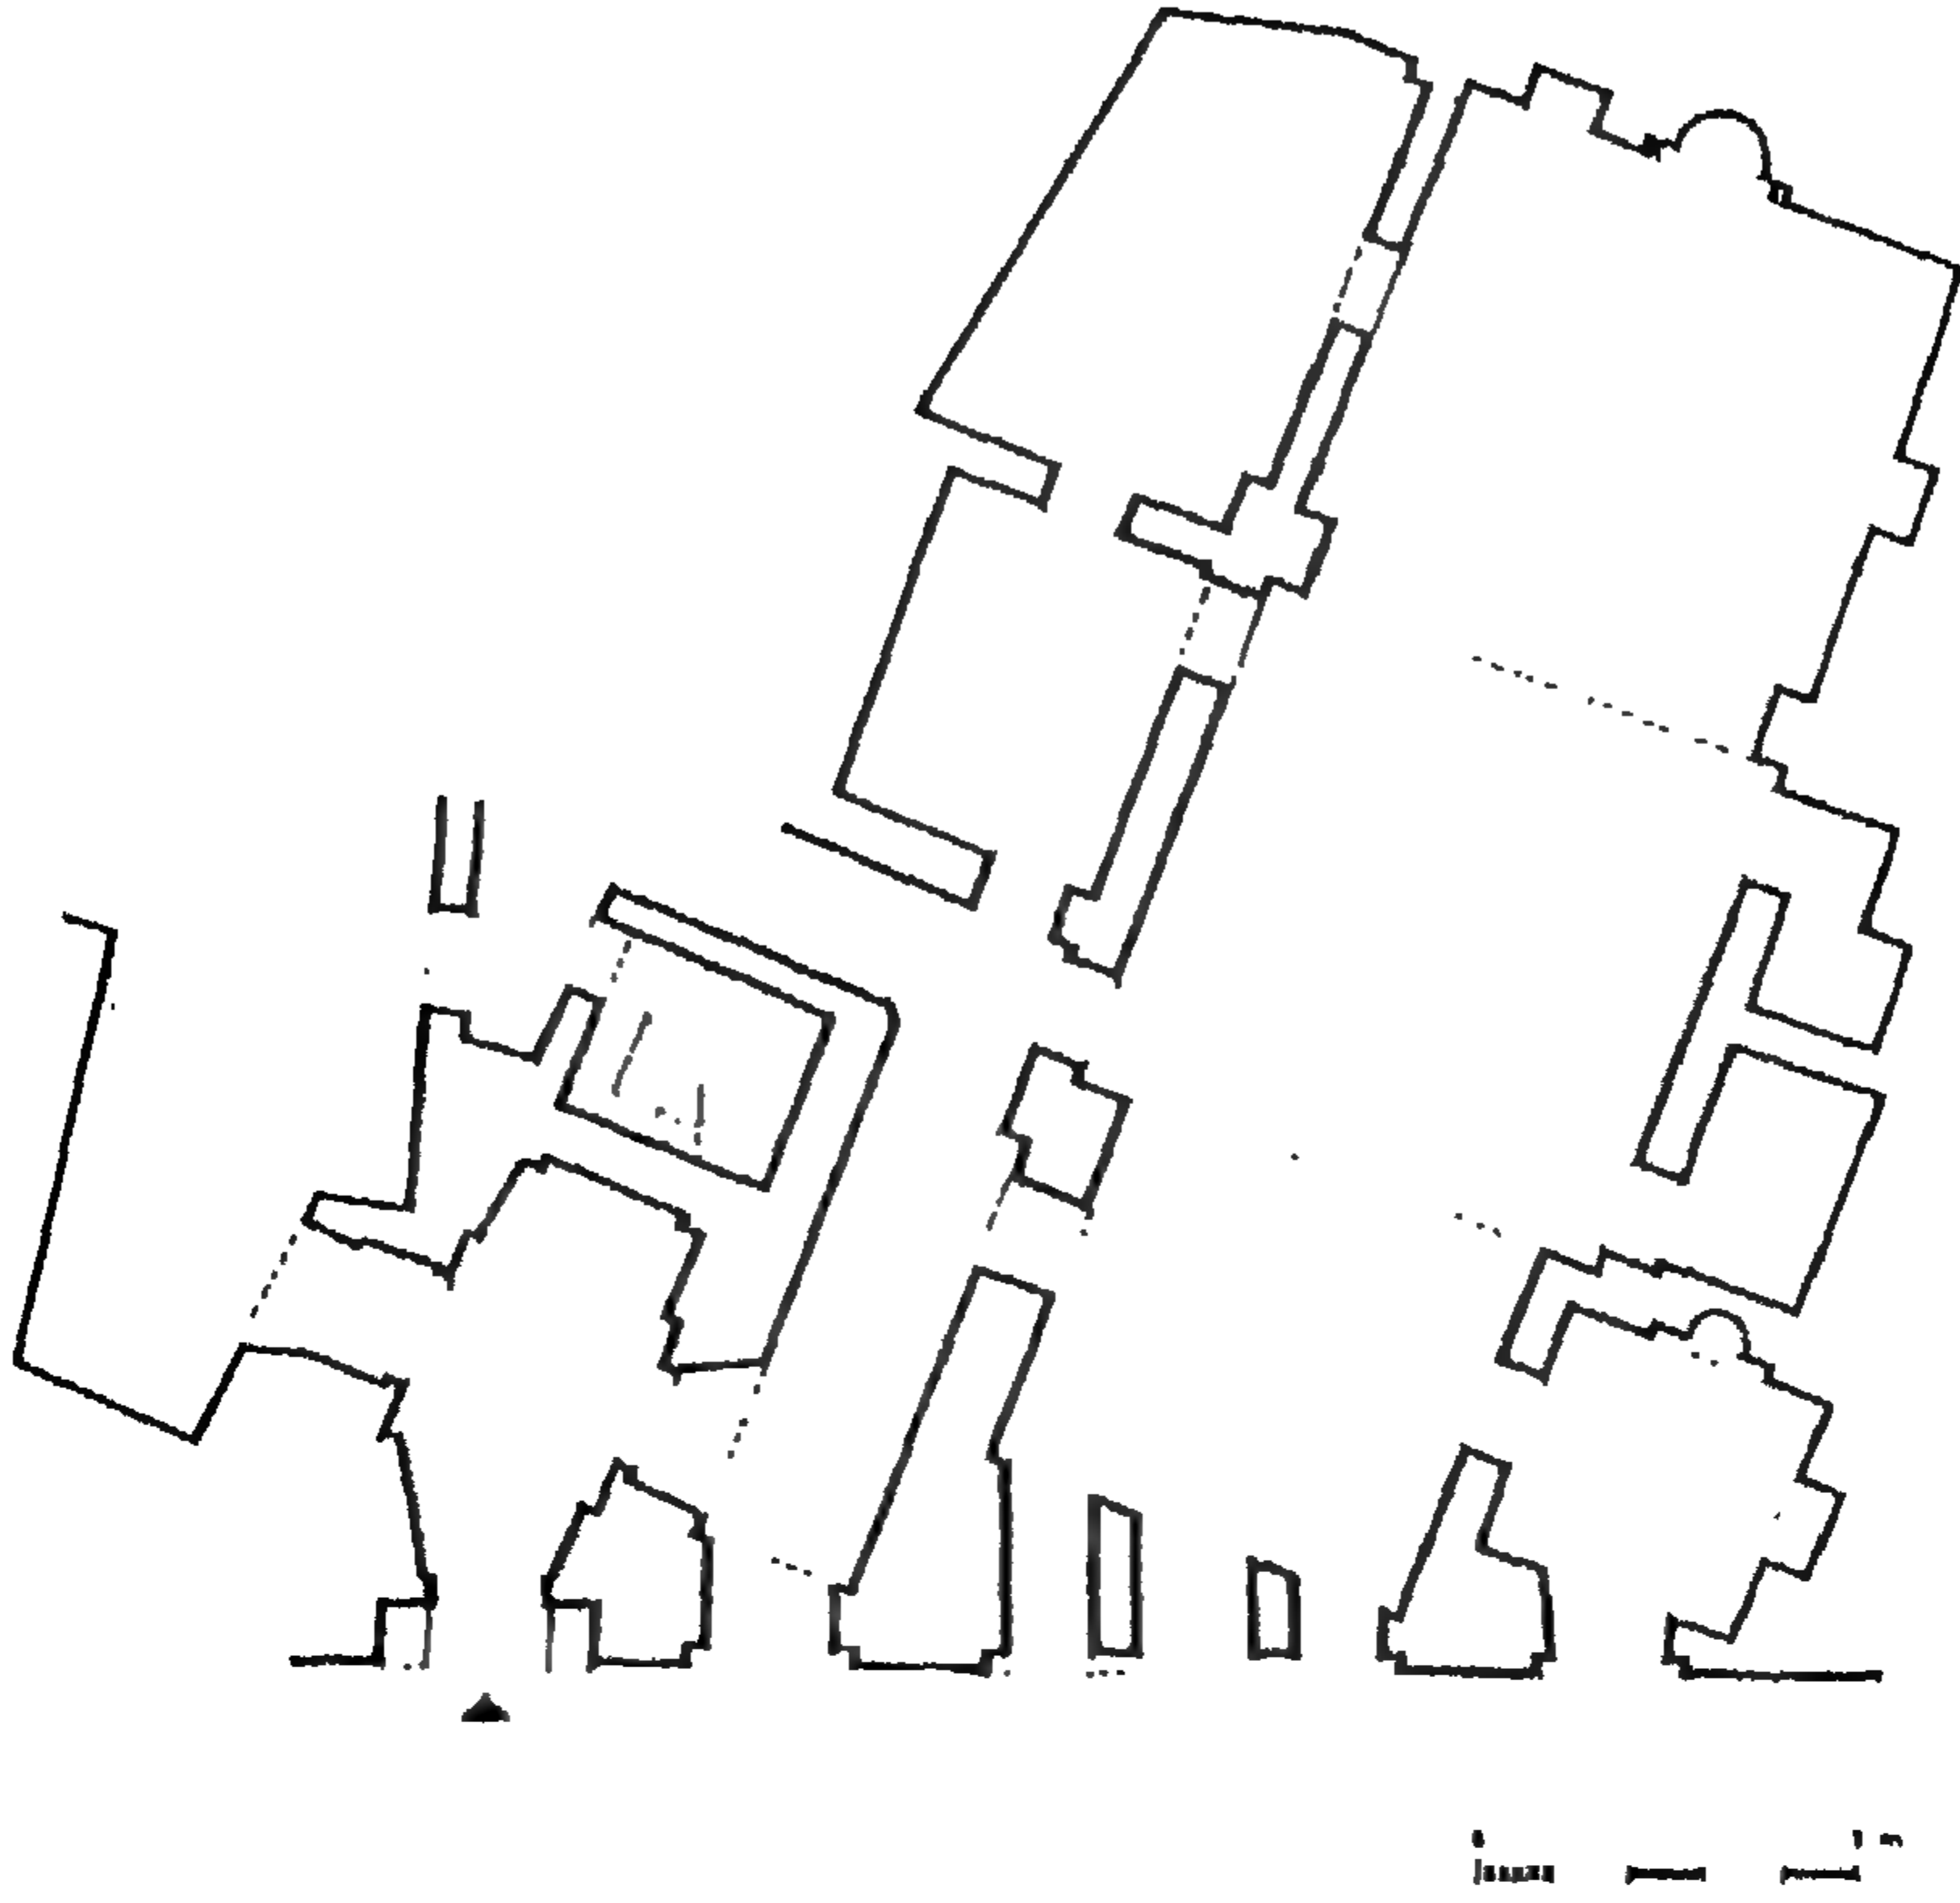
مسقط أفقي لجامع البرديني بالقاهرة .
